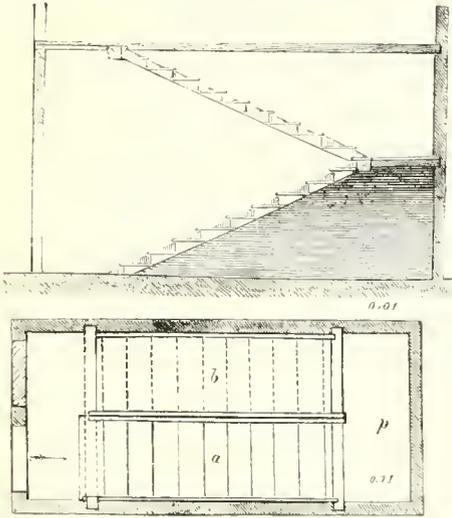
Élévation et plan d'un escalier à deux volées (échelle 0.01 par mètre).
